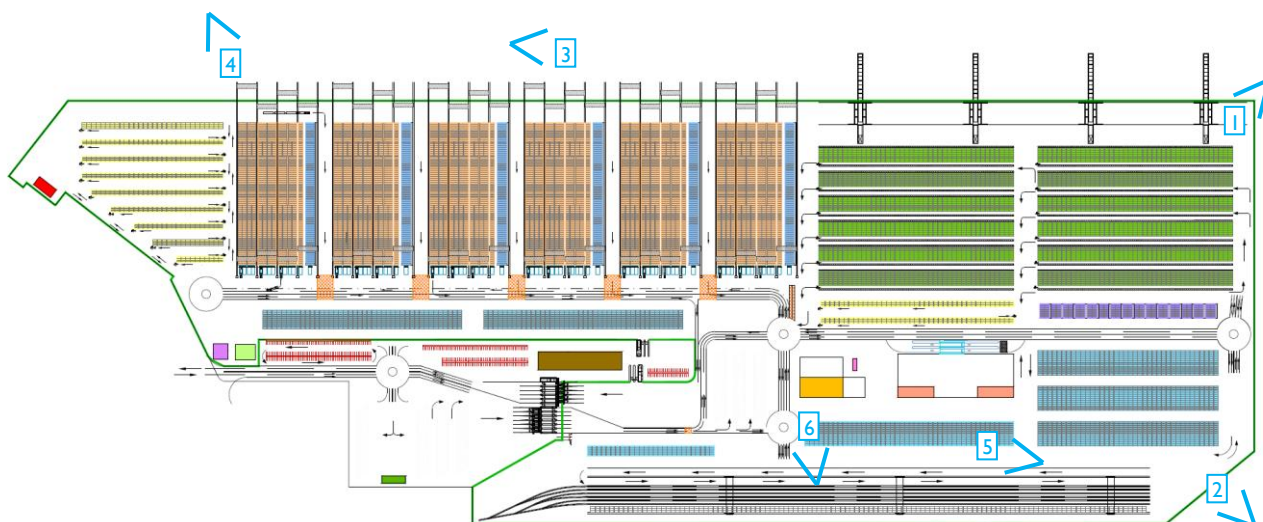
Planimetria con le viste dello stato di progetto dell'Area di Intervento
